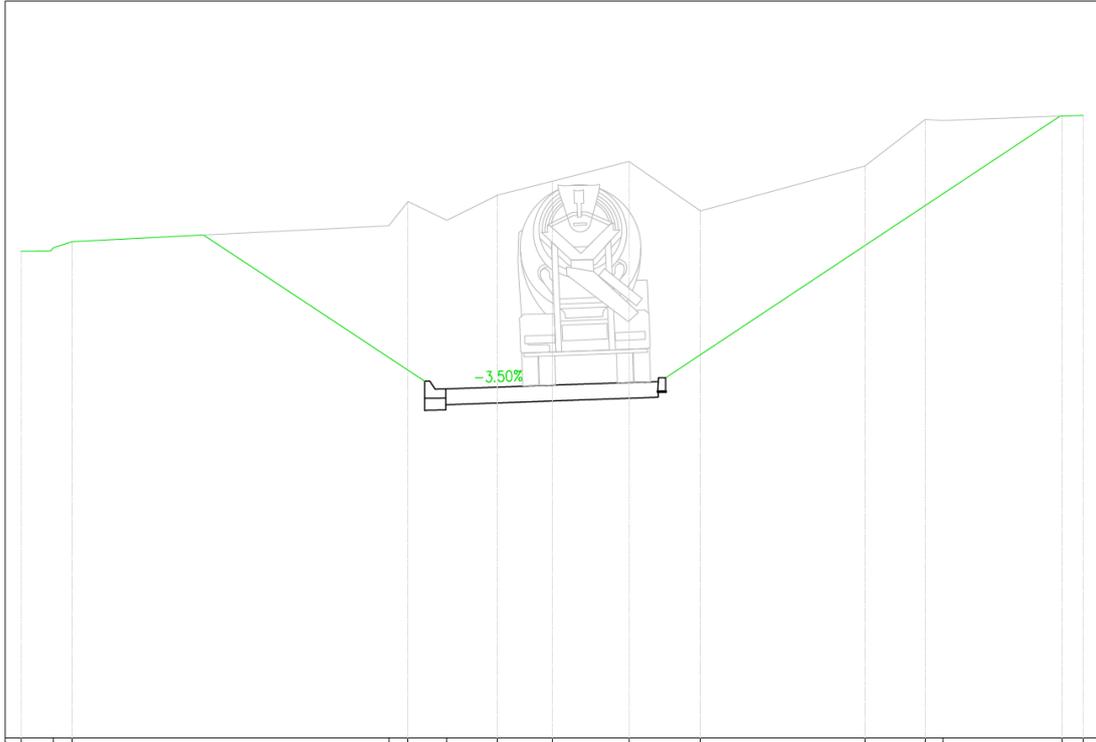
Estratto della sezione tipo del primo tratto, in trincea rispetto al terreno esistente
